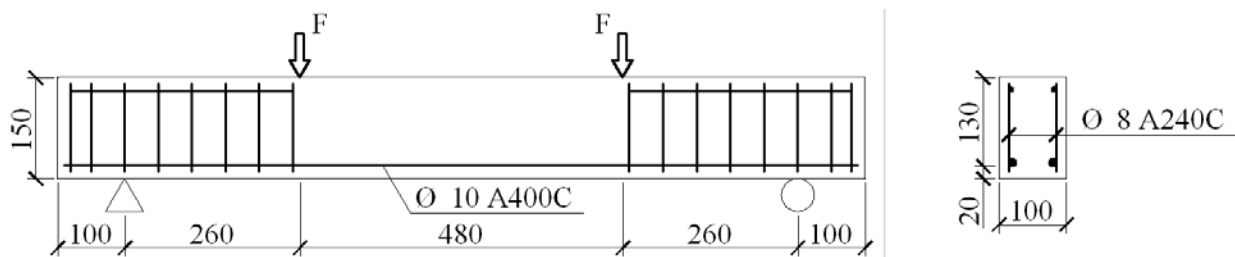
Расчетная схема, геометрические размеры и армирование балки
